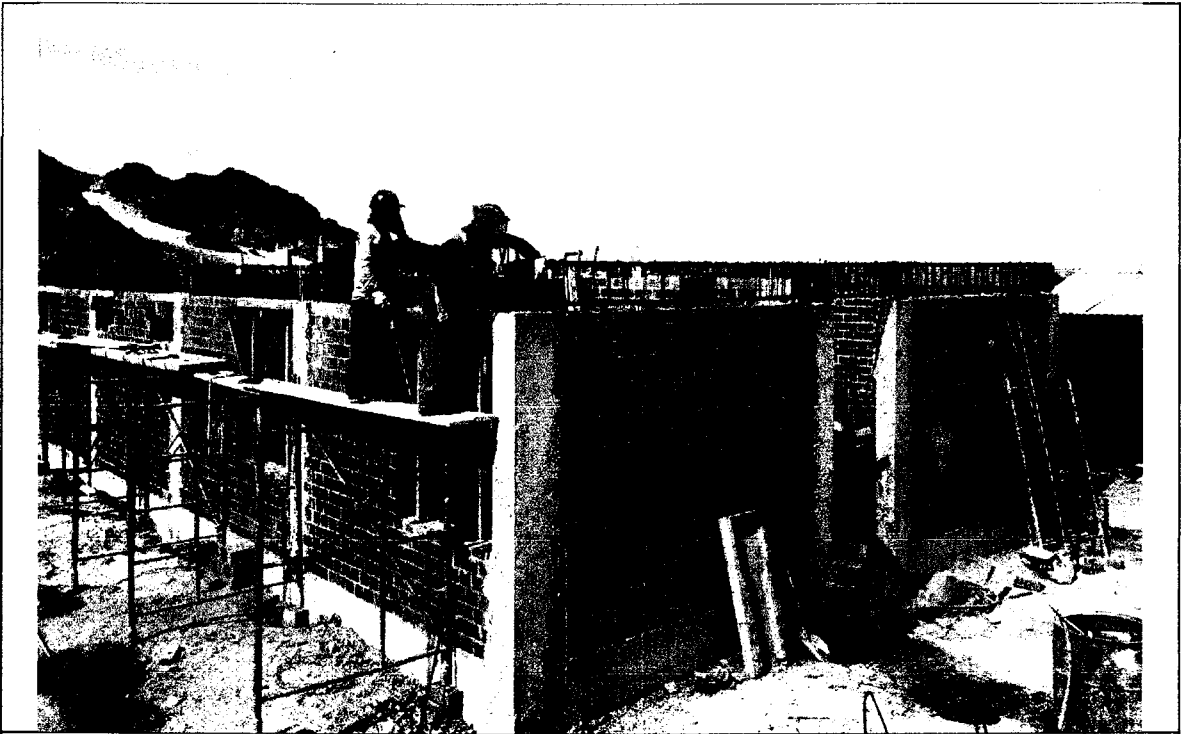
ARMADO DE ACERO DE REFUERZO EN VIGAS DEL MODULO I.
